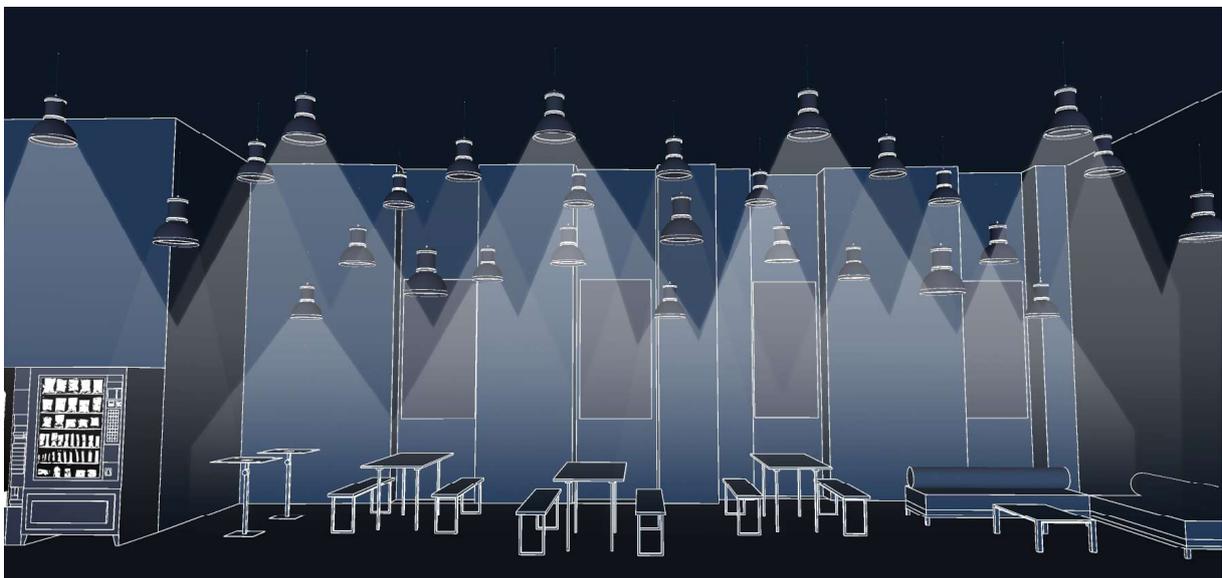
Schizzo progettuale aula tipo Spazio studenti, sezione longitudinale.
